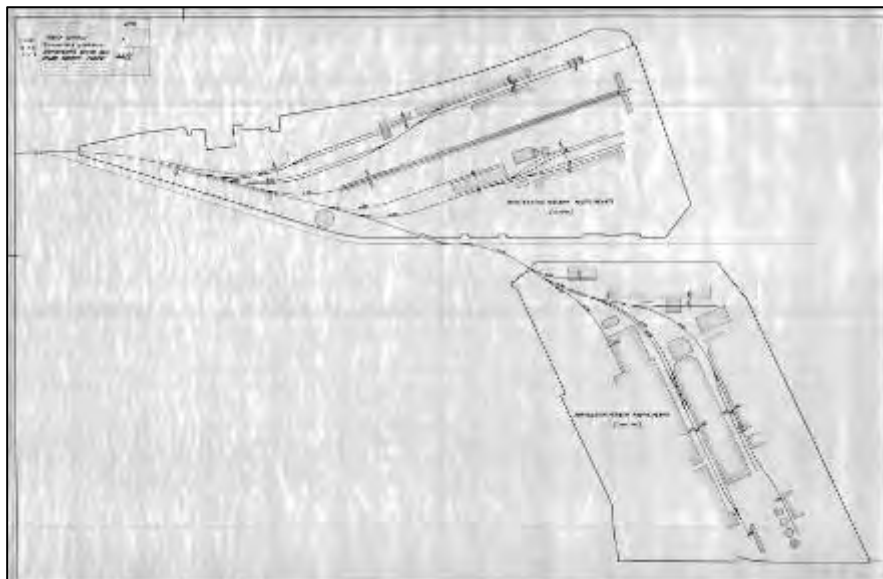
1967, "planimetria generale disposizione binari agli stabilimenti concimi e ceneri" (Fonte: disegno su lucido originale dell'archivio "Fertimont")
